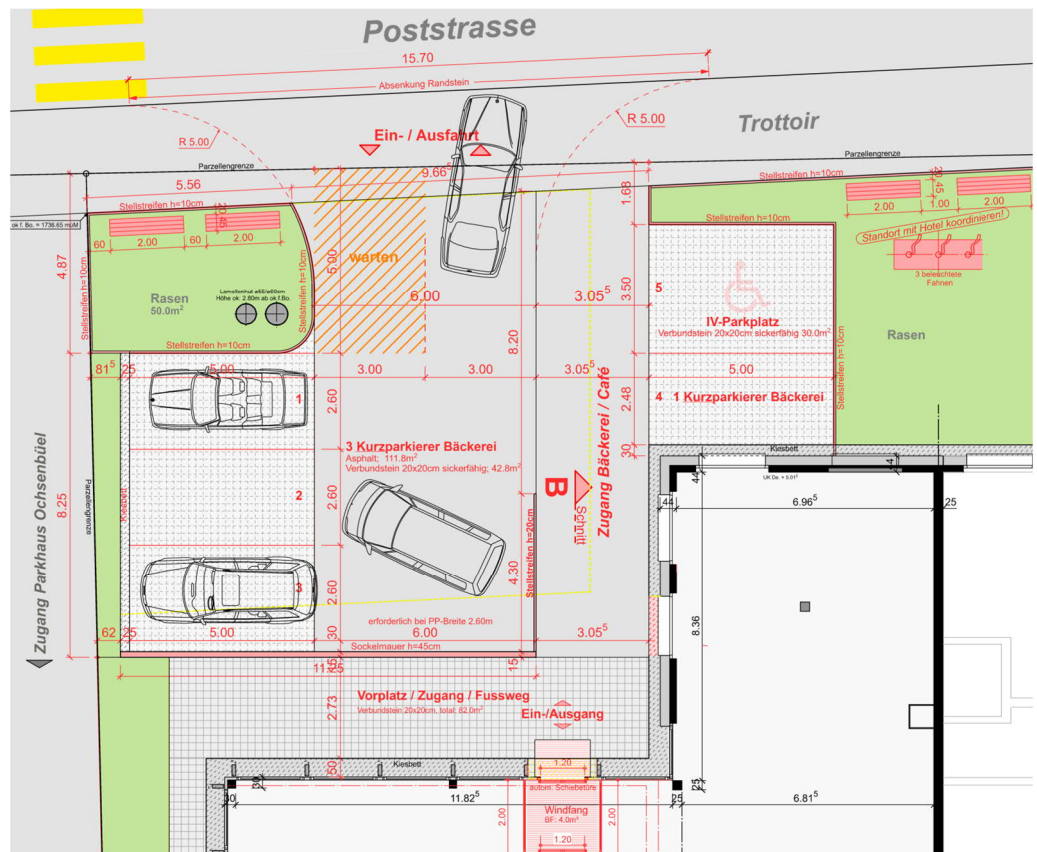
Übersicht Plan «Parkierung Kurzzeitparkierer» (massstabslos)
